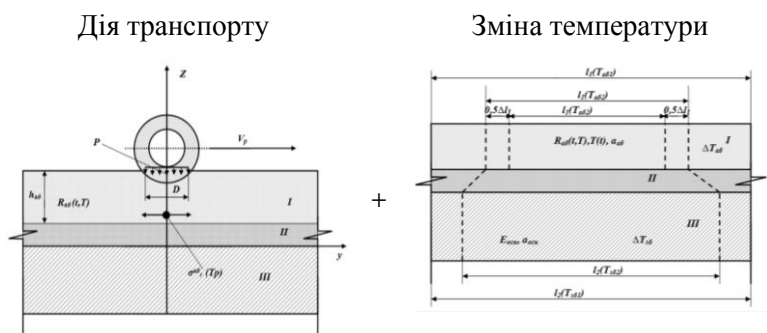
Розрахункові схеми асфальтобетонного покриття (I) яке зв'язане з основою із залізобетону (III): розрахункова схема асфальтобетонного покриття (I), яке зчеплене з основою із залізобетону (III) через податливий еластичний прошарок (II); $R_{аб1}(t, T)$ – функція релаксації асфальтобетонного покриття; $\sigma_{аб1}(T_p)$ – розтягуючі напруження від часу дії транспорту та функції релаксації асфальтобетонного покриття; V_p – швидкість транспортного засобу; $E_{осн}$ – модуль пружності залізобетонної основи; $\alpha_{аб1}$, $\alpha_{осн}$ – коефіцієнт лінійного температурного розширення асфальтобетону та залізобетону відповідно; $\Delta T_{аб}$, $\Delta T_{зб}$ – зміна
